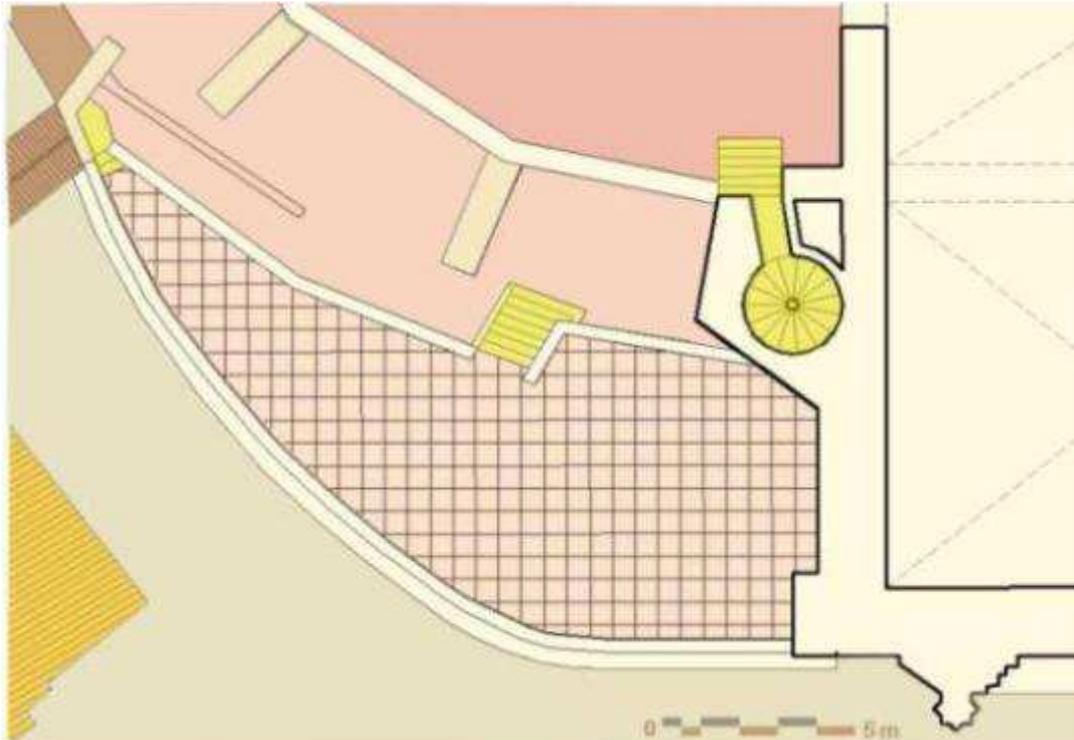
18.5 Planta general de cubiertas estado actual.
